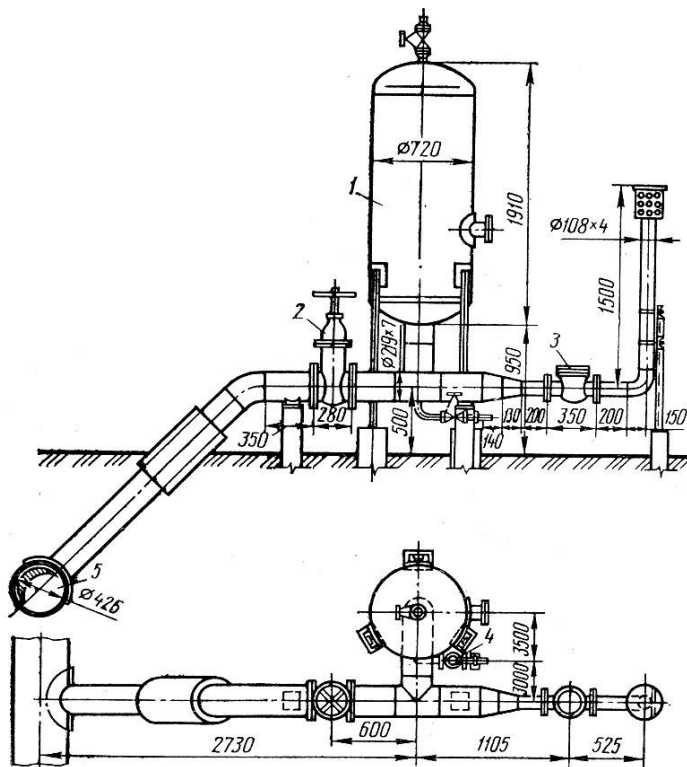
Водовоздушный резервуар с устройством для впуска воздуха: 2-задвижка; 4-запорный вентиль.
